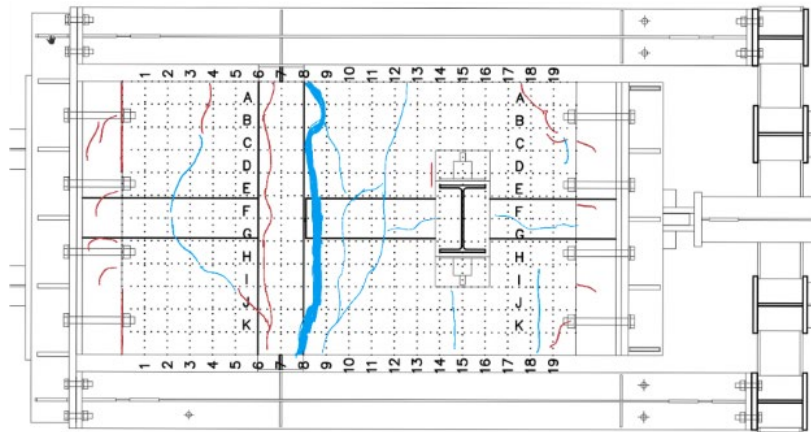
実験後スラブ上端のひび割れ
